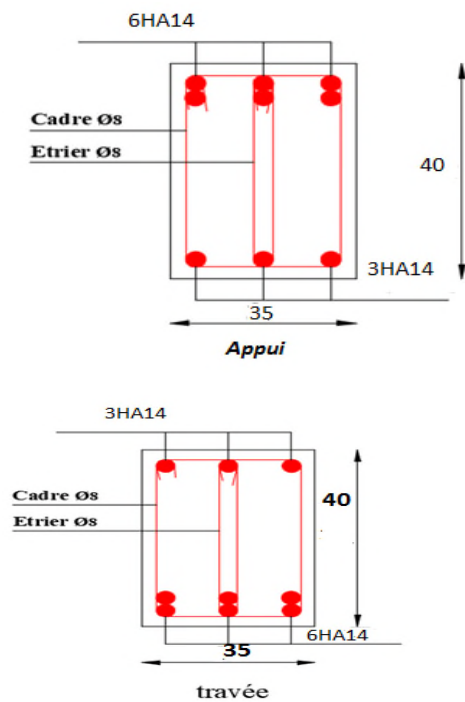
Schéma de ferrailage de la poutre secondaire de RDC+SS
